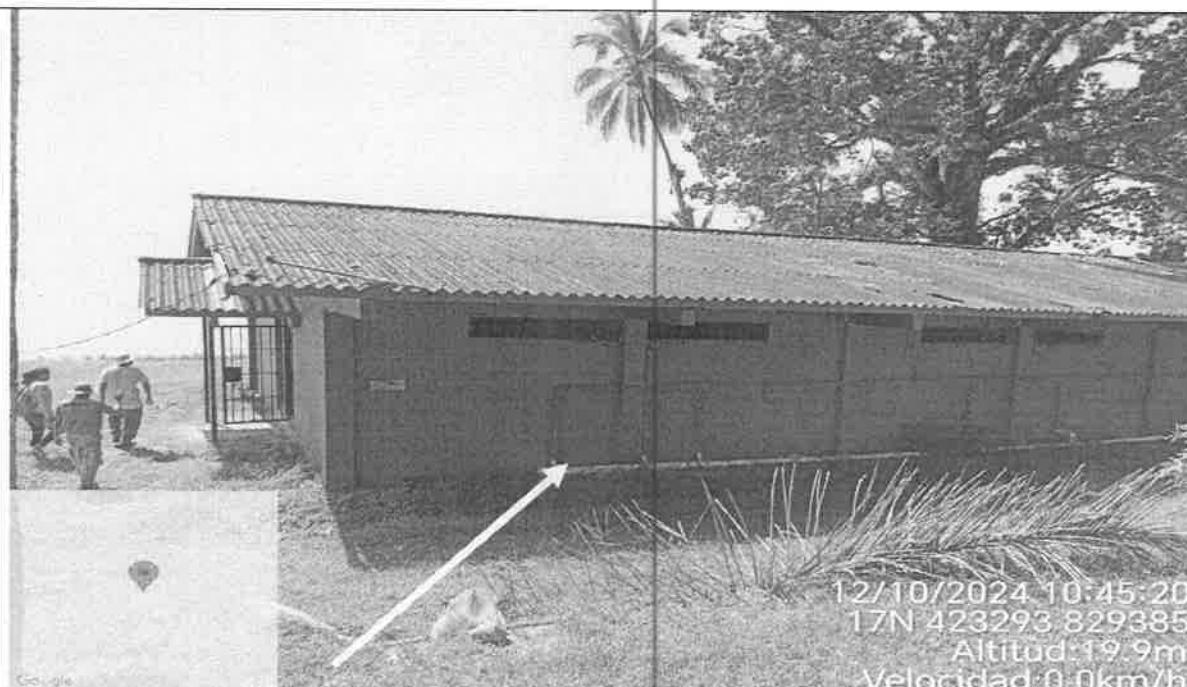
Vista exterior del edificio preventiva sur. Se observa Tuberias conectadas a un tanque septico.
